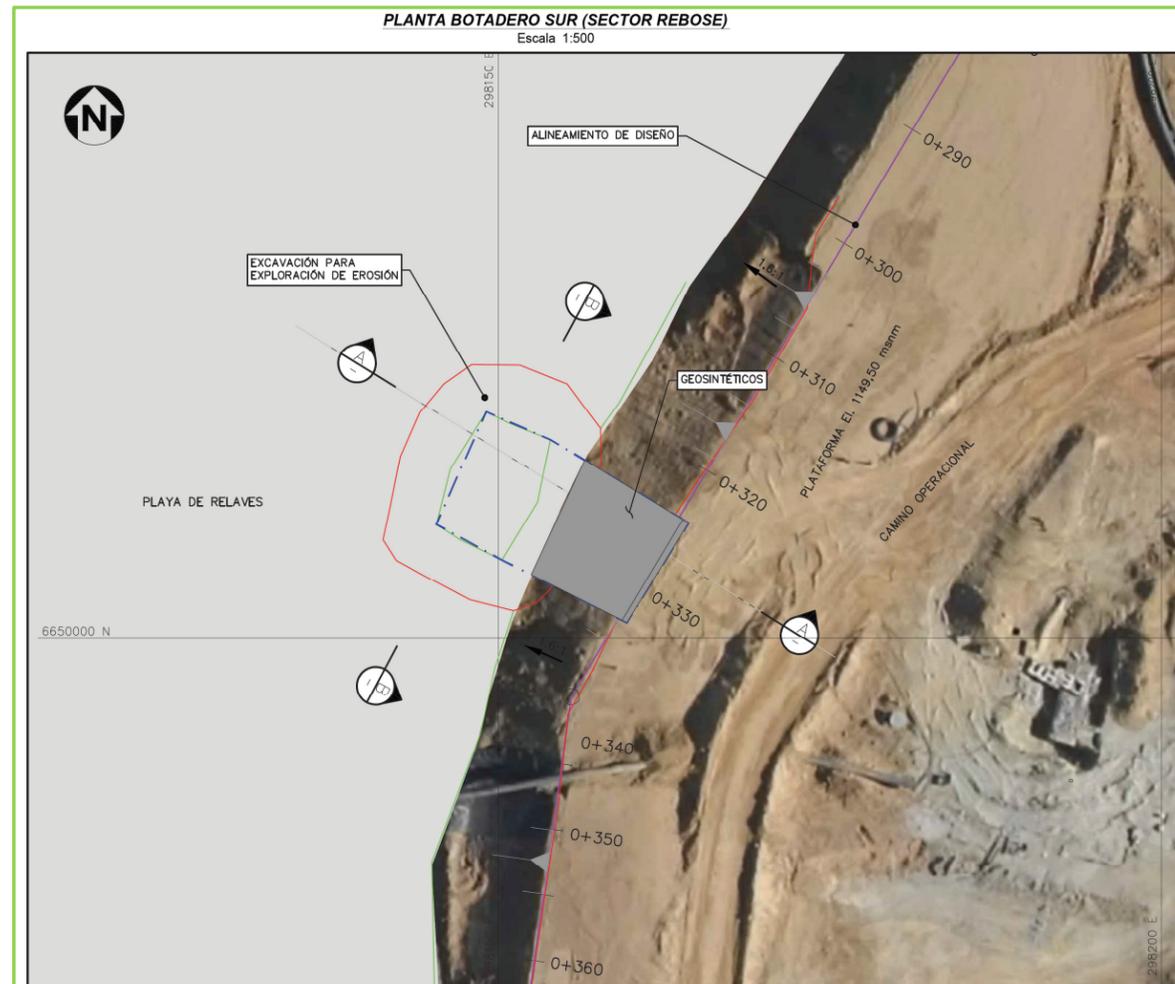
BS, As Built y respaldo de la reparación para erosión de talud sector Rebose TK-042, Plano E40165-840-R-PL-155\_RB (ref. Wood).
